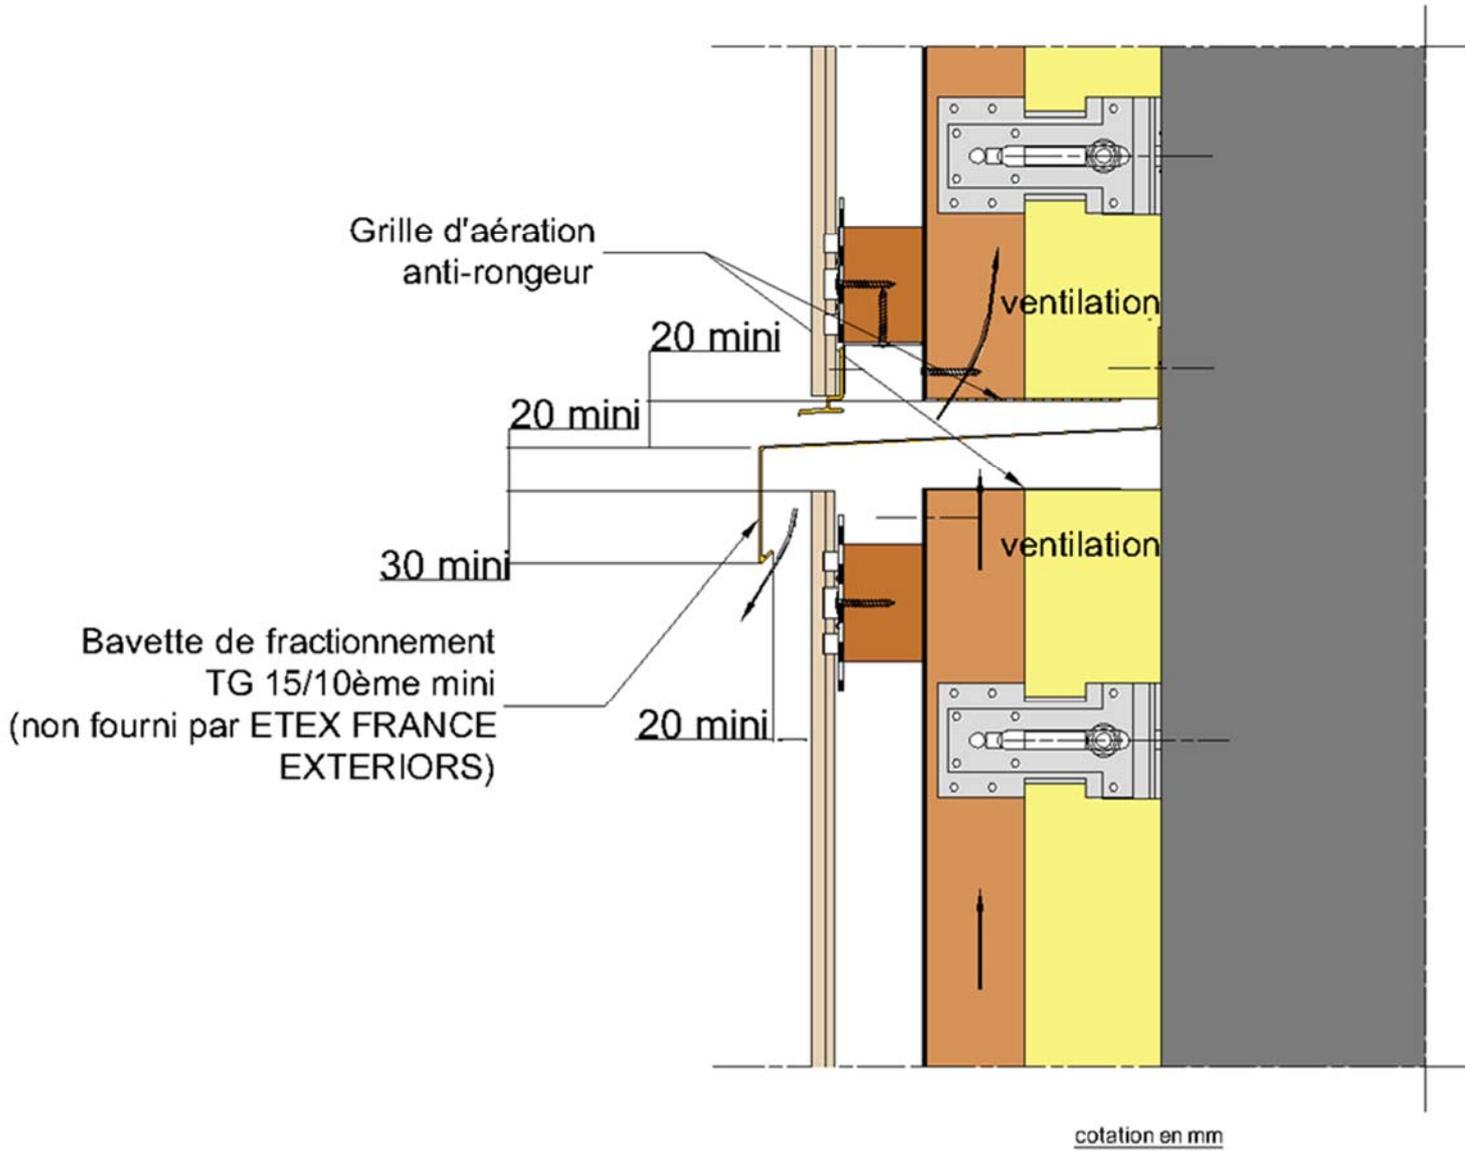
Joint horizontal en pose verticale tous les 3,6 m
